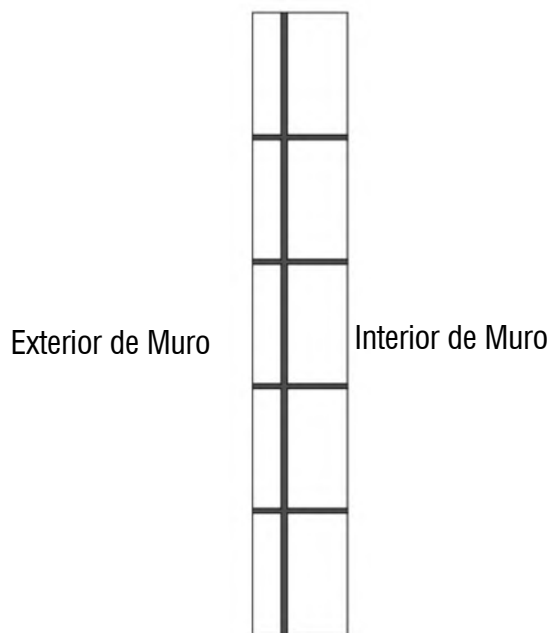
Muro de 30 cm y disposición en planta de block de adobe
